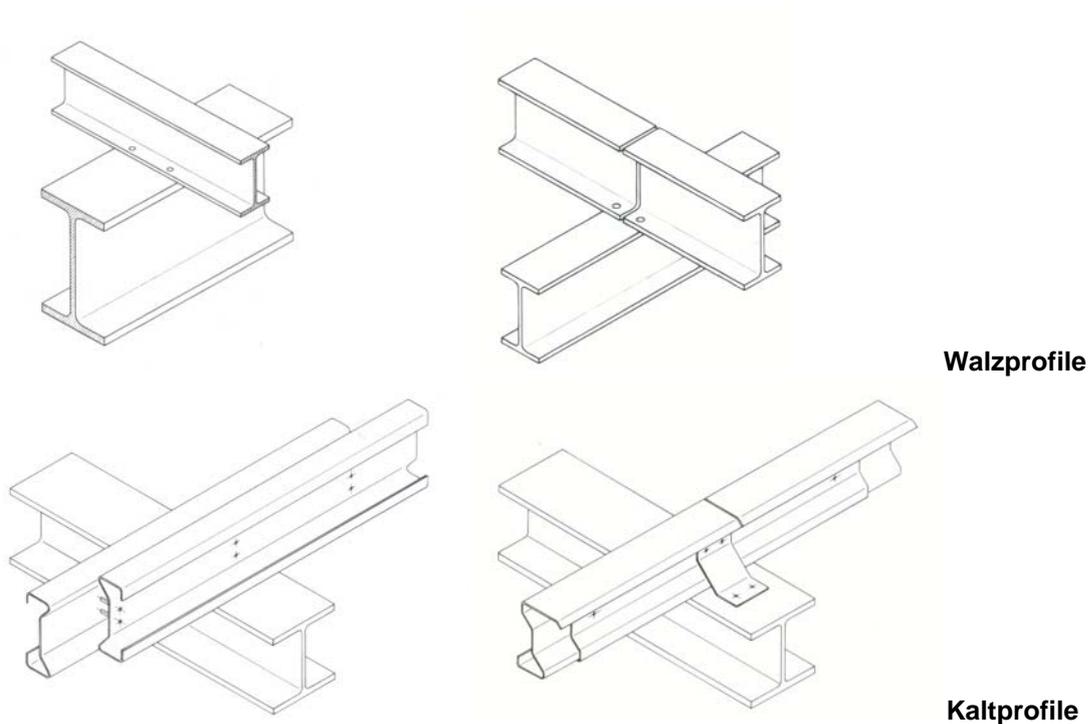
Auflagerung für durchlaufende und endgelagerte Pfetten
